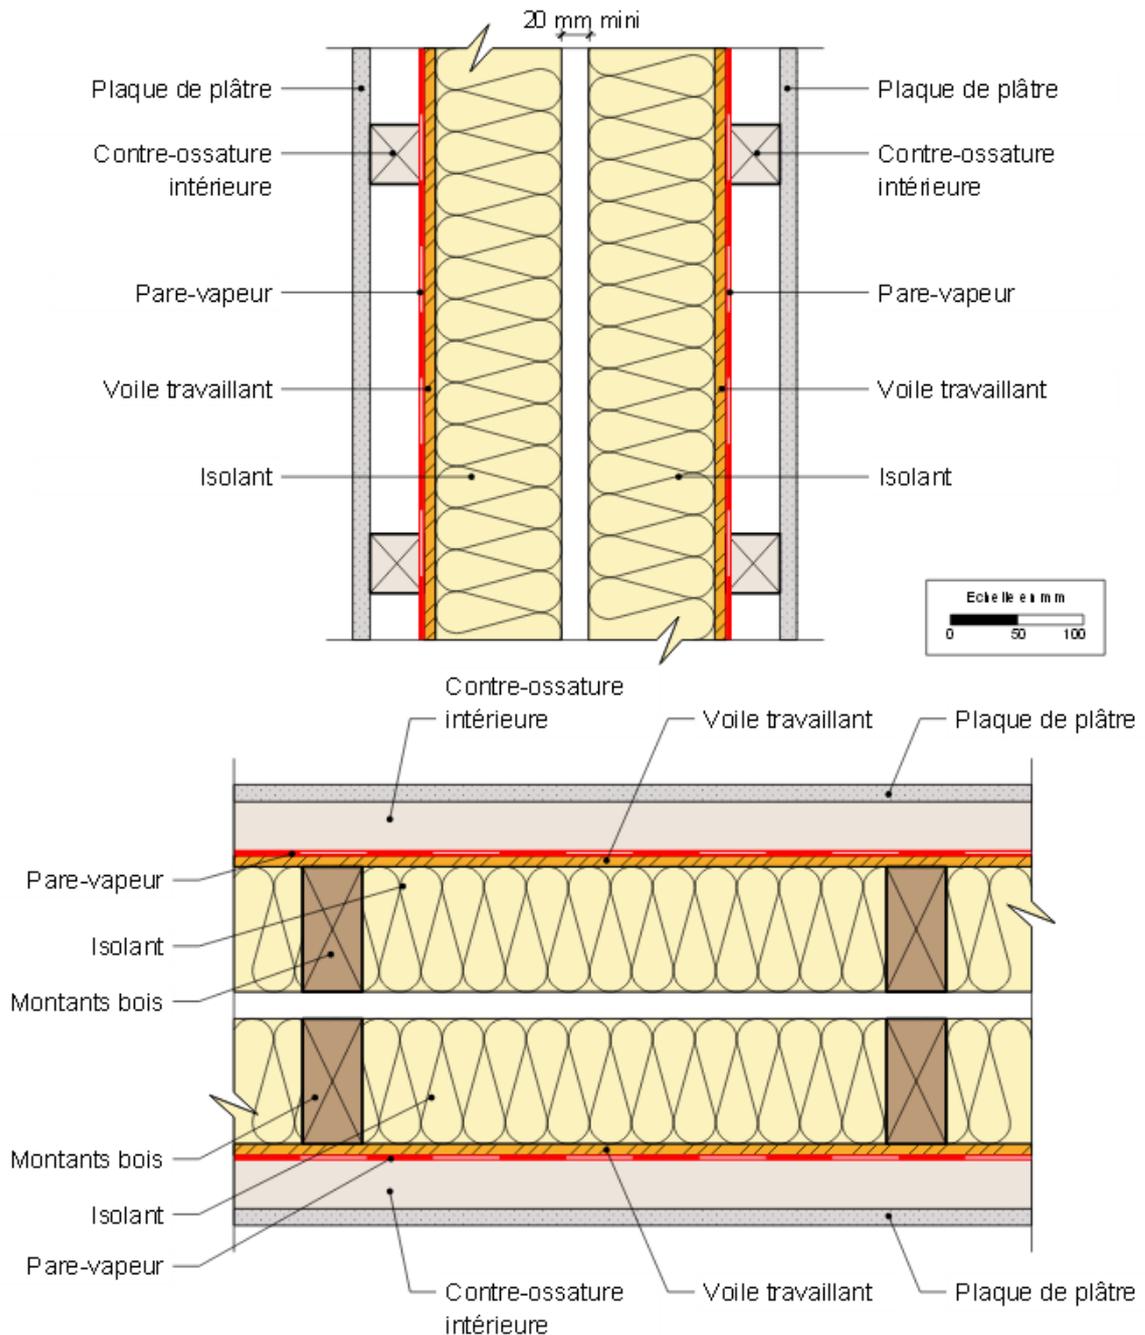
Contreventement côté intérieur avec tasseautage support de parement (coupe verticale en haut, verticale en bas)
